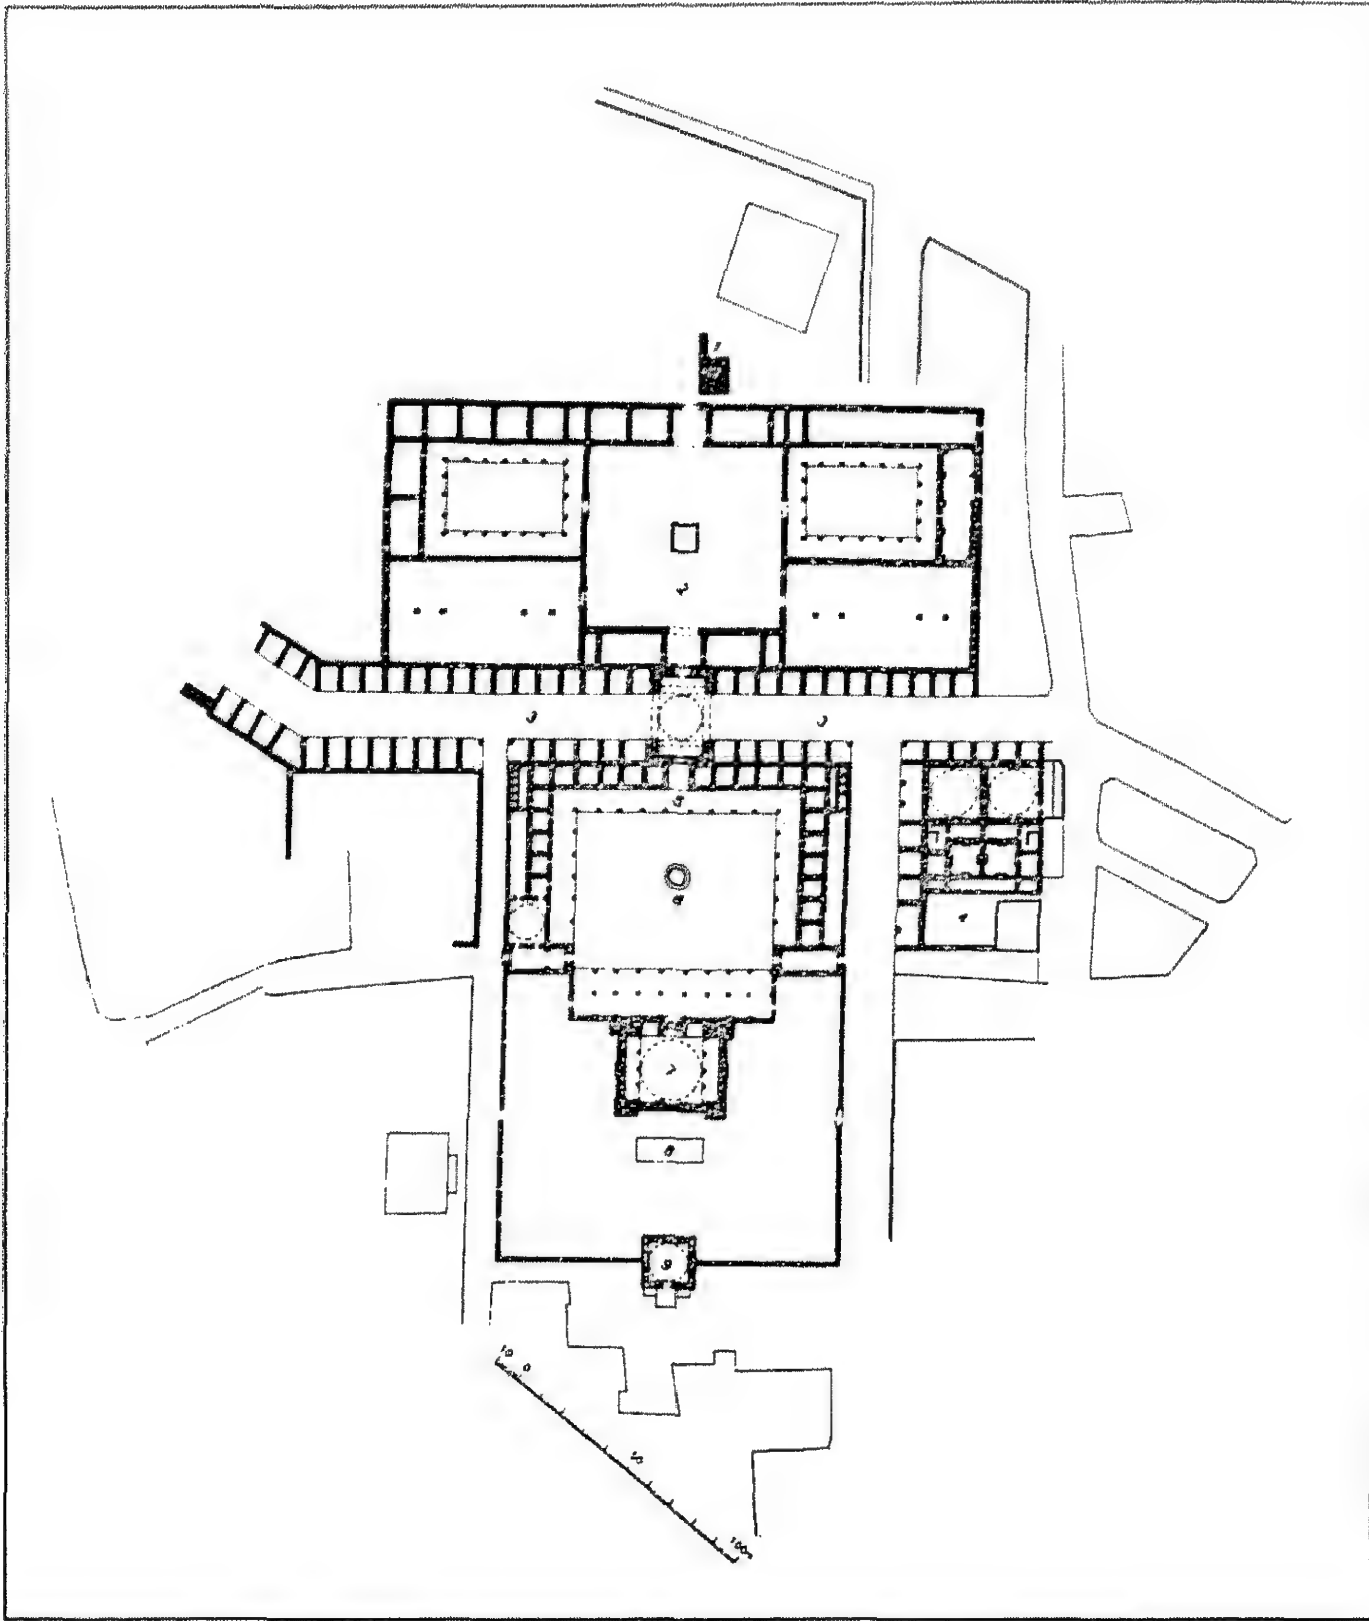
مسقط أفقي لمدرسة محمد باشا في فوتچا (عن: Pašić).
